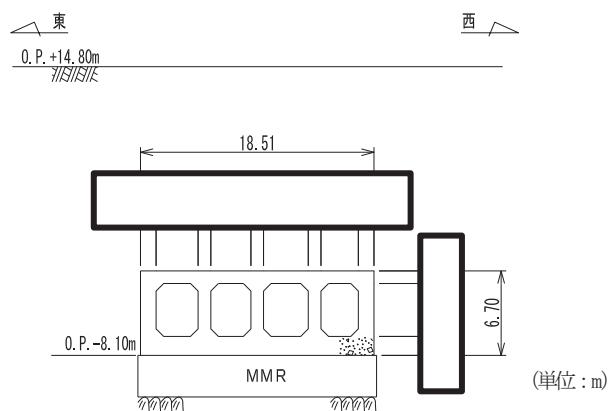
取水路（漸拡部）断面図（C-C 断面：断面②）
